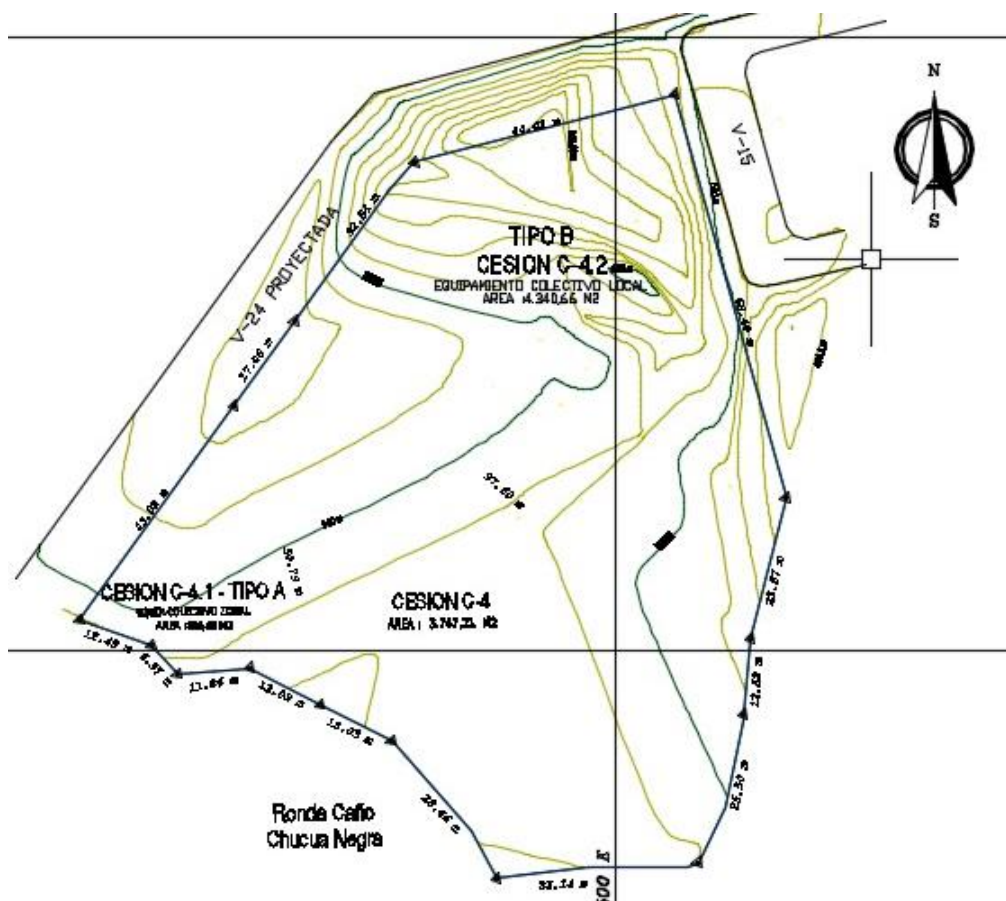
Plano de levantamiento topográfico con las curvas de nivel de la zona del proyecto.
